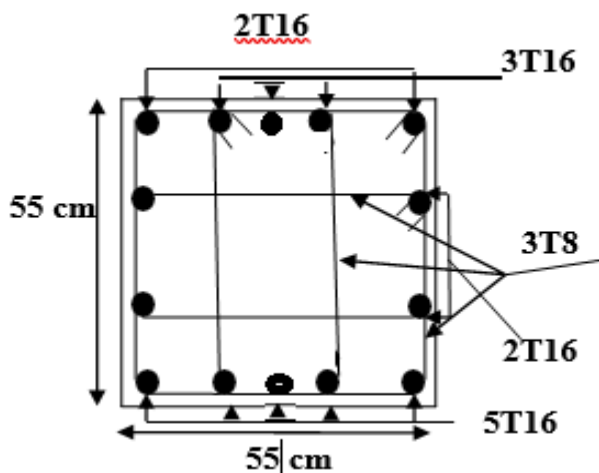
Ferrailage des poteaux de RDC,1eme étage
